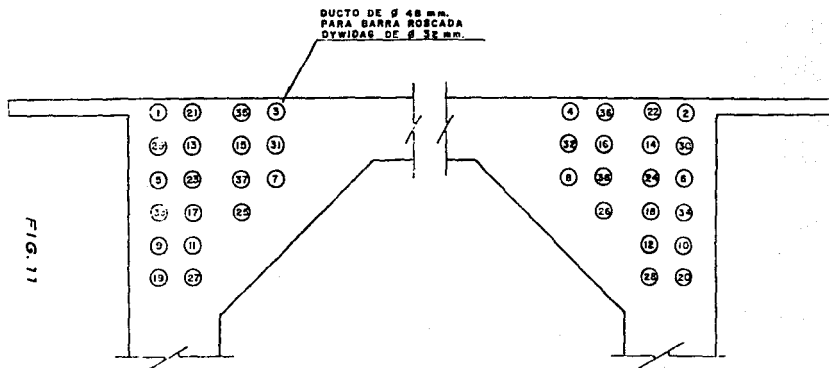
En la parte superior de las Pilas principales donde quedará la unión entre el cuerpo de las pilas y la losa inferior de la superestructura, se está ampliando la sección de concreto de los muros para alojar 38 barras de presfuerzo tipo Dywidag de 1 1/4 " de diámetro, con el fin de transmitir los esfuerzos que provocará la superestructura durante su construcción hacia el cuerpo de pila.
